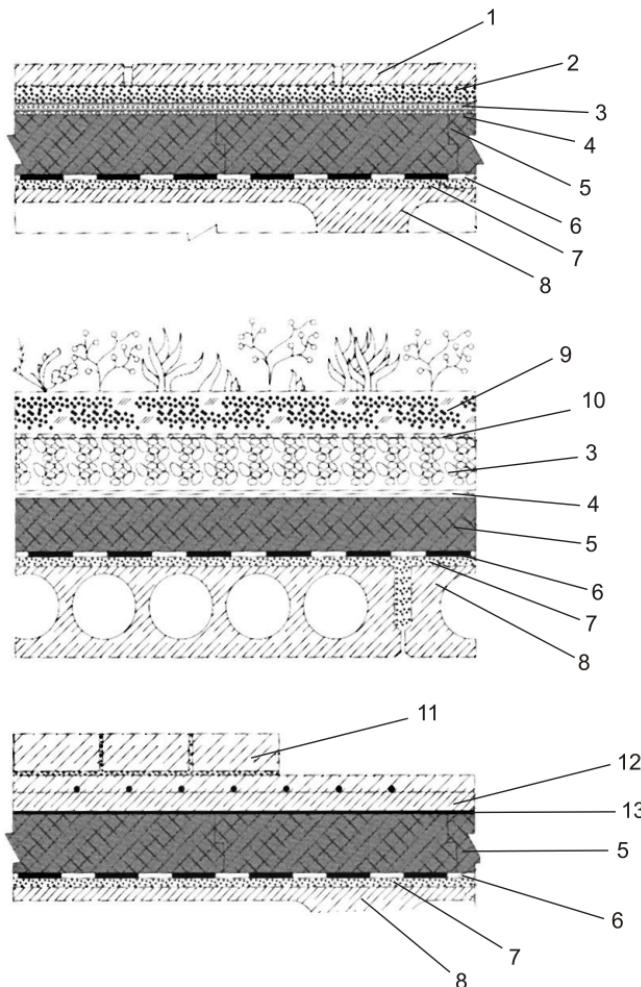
Эксплуатируемые инверсионные кровли: 1 — плиты тротуарные; 2 — песок; 3 — дренажный слой из гравия фракции 10—20 мм; 4 — фильтрующий слой (геотекстиль); 5 — ПЕНОПЛЭКС; 6 — гидроизоляция кровли рулонным материалом; 7 — уклонообразующая цементно-песчаная стяжка; 8 — железобетонная плита перекрытия; 9 — растительный слой; 10 — противокорневой слой; 11 — плиты тротуарные на растворе; 12 — армированный железобетон; 13 — полиэтиленовая пленка
